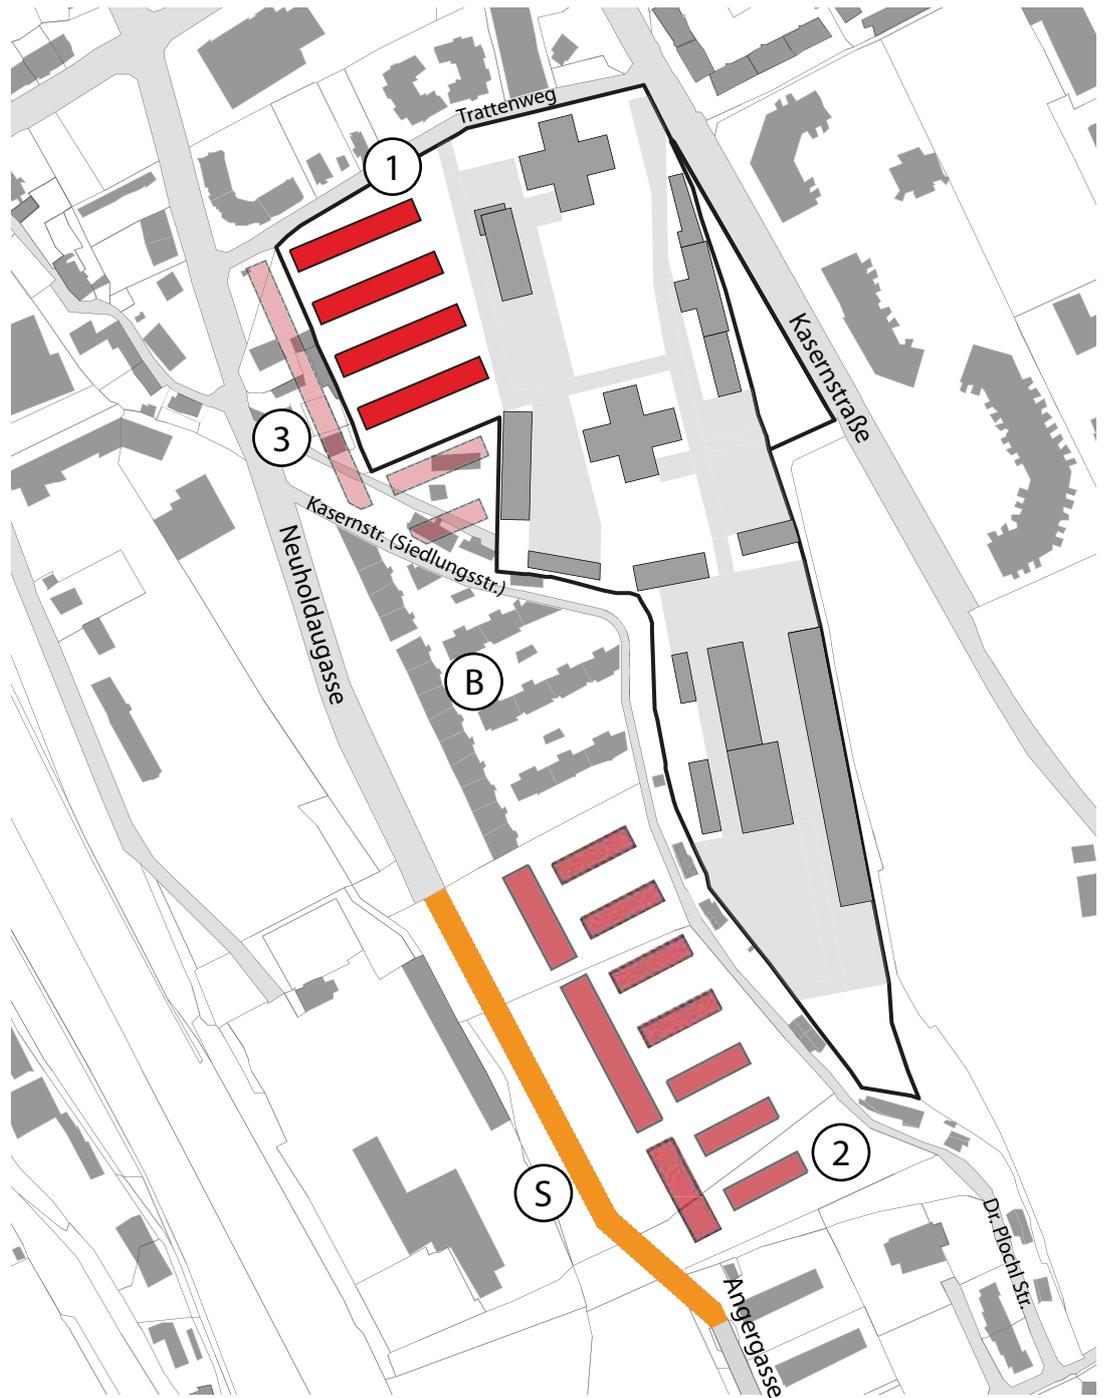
Lageplan - Städtebauliche Maßnahmen
